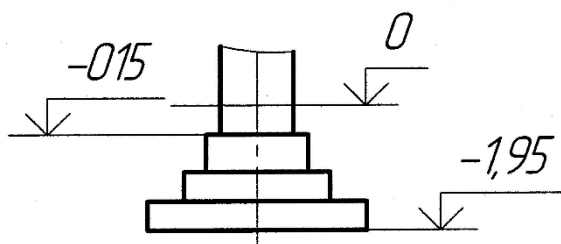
Фундамент под колонны серии КЭ – 01 – 49
